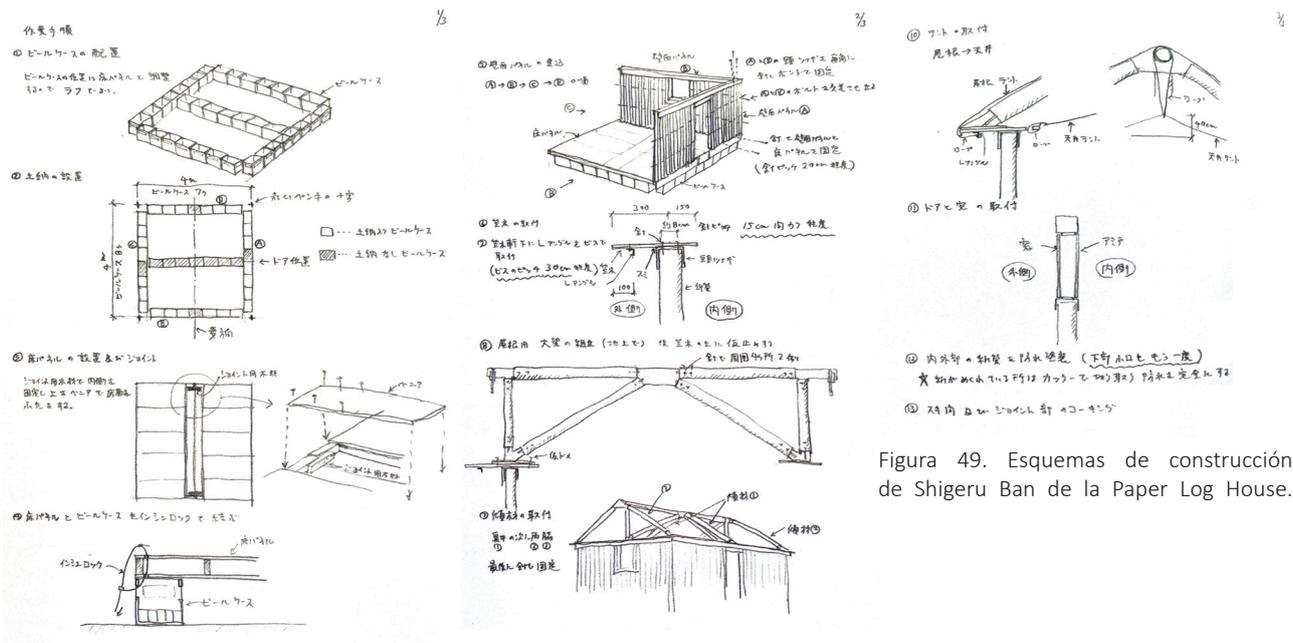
Esquemas de construcción de Shigeru Ban de la Paper Log House.
